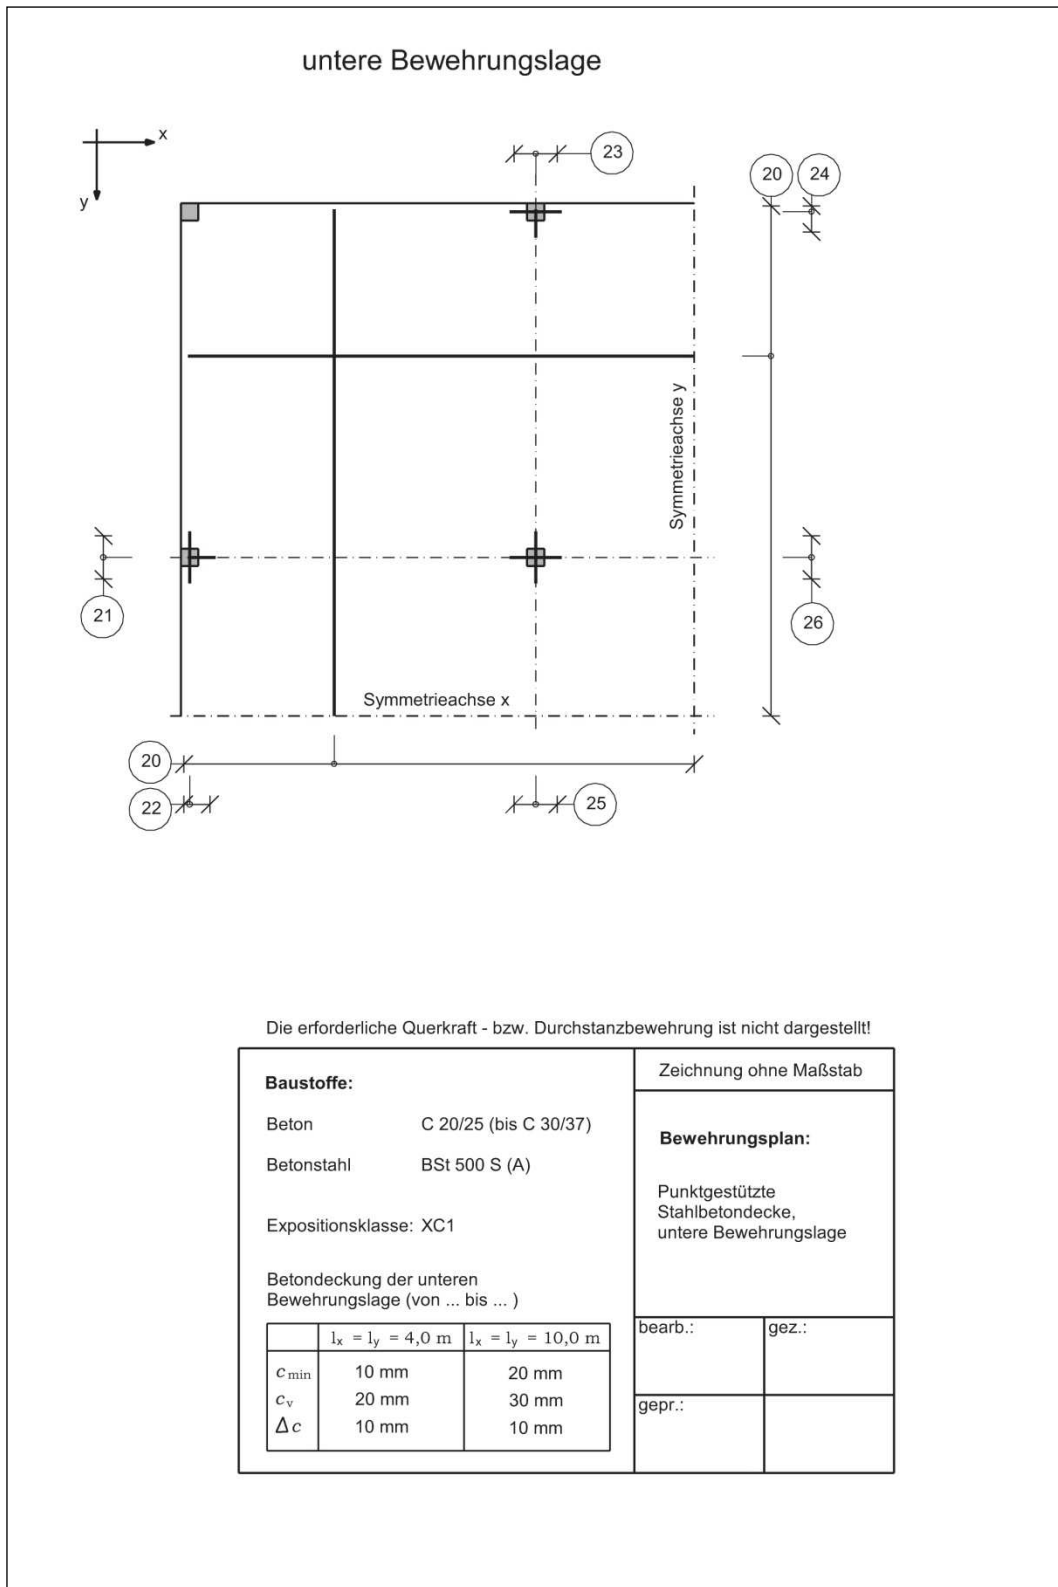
Bewehrungsplan der unteren Bewehrungslage für die untersuchten punktgestützten Stahlbetonplatten (schematisch)
